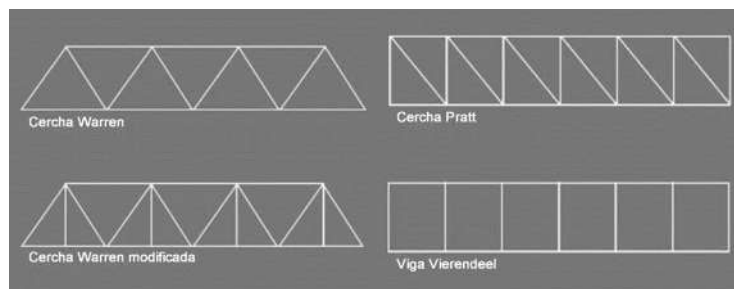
Tipos de armaduras y viga Vierendeel para estructuras de puentes peatonales
